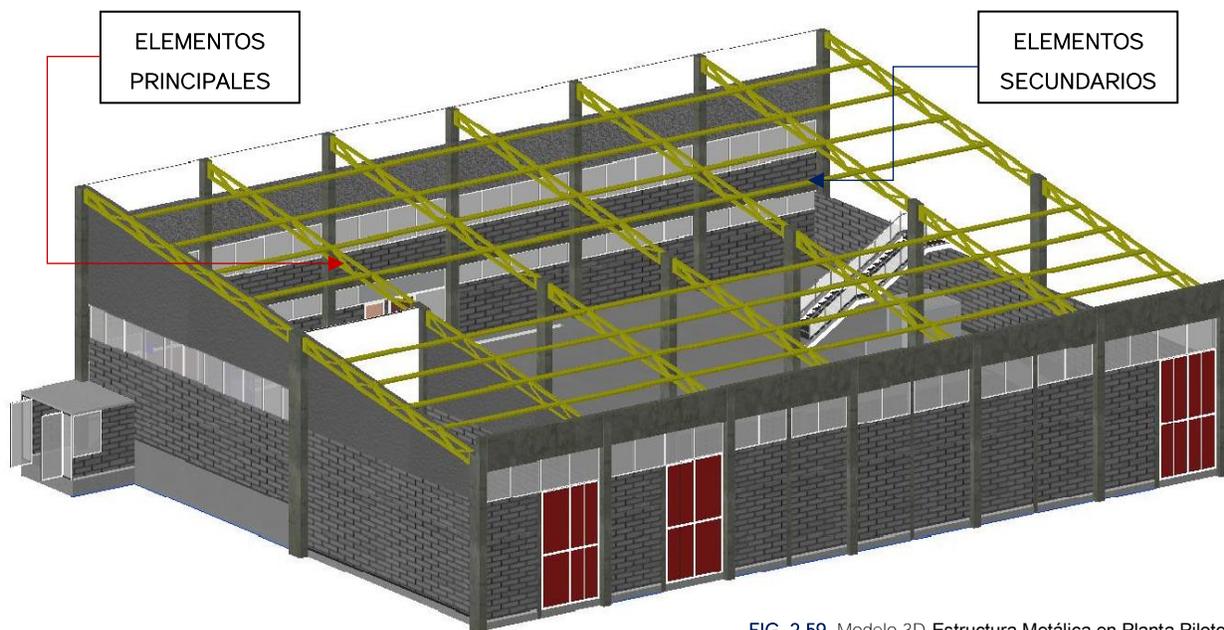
Modelo 3D-Estructura Metálica en Planta Piloto.
